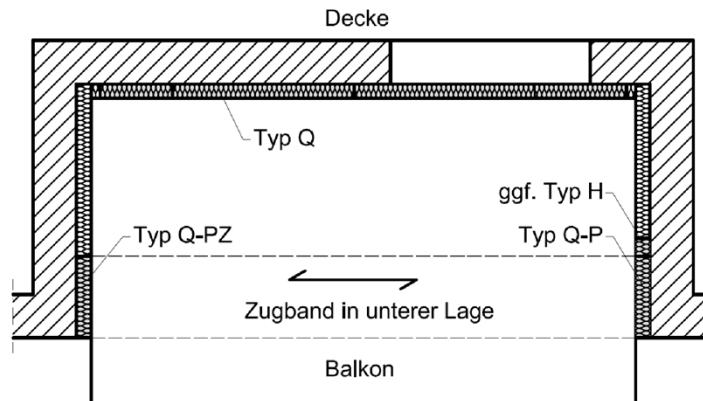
Zwängungsfreie Anwendung: Beispiel Schöck Isokorb® Typ Q-Z, Q-PZ (ohne Druckelemente) mit gegenüberliegenden Plattenanschlüssen Schöck Isokorb® Typ Q, Q-P (ggf. mit Typ H)
